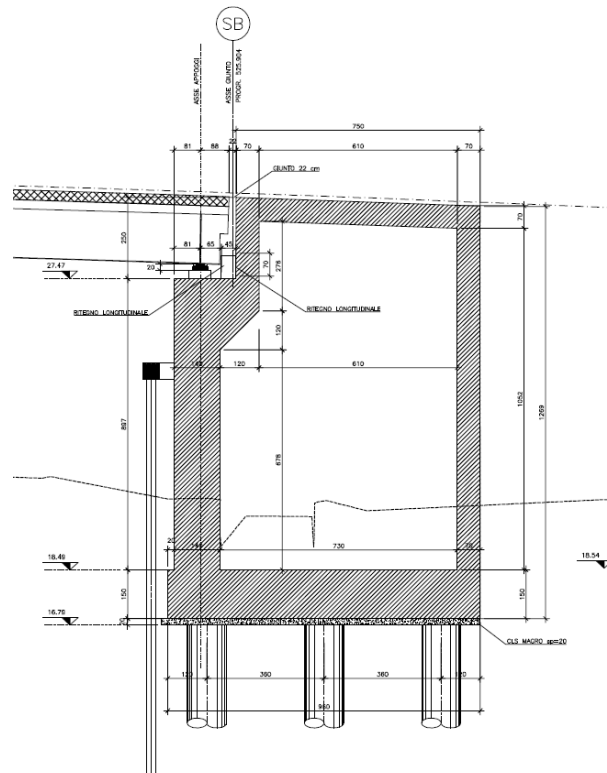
Sezione longitudinale - Spalla B
